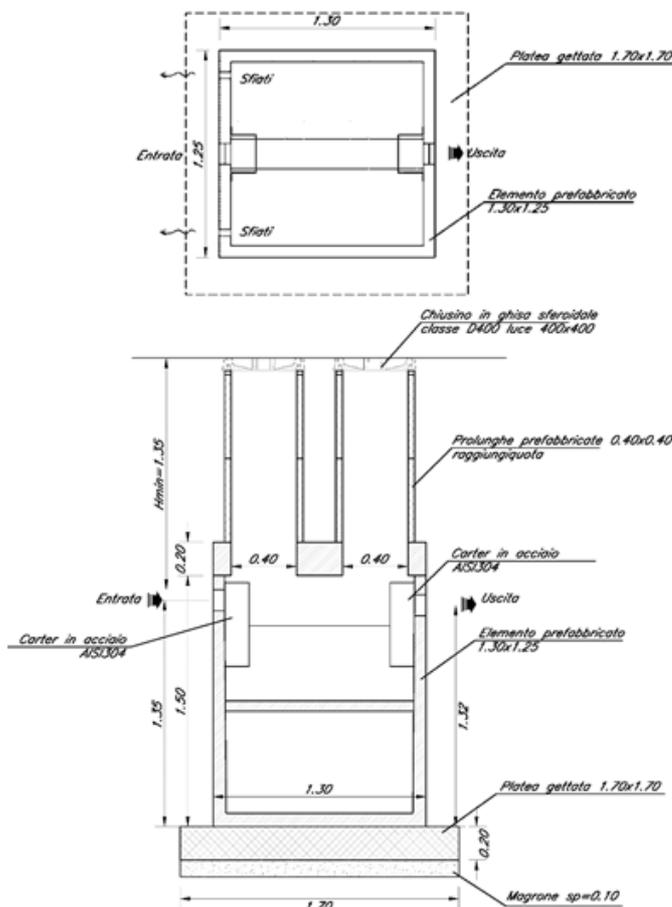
Vasca Imhoff – Pianta e Sezione
